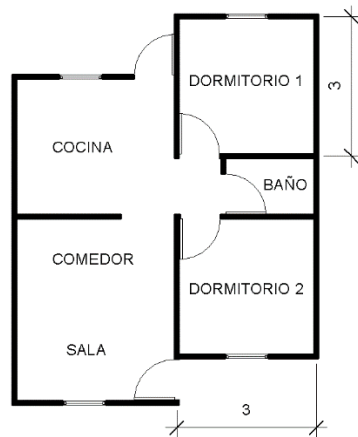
Planta arquitectónica vivienda social. Chaves, J. (2019).
